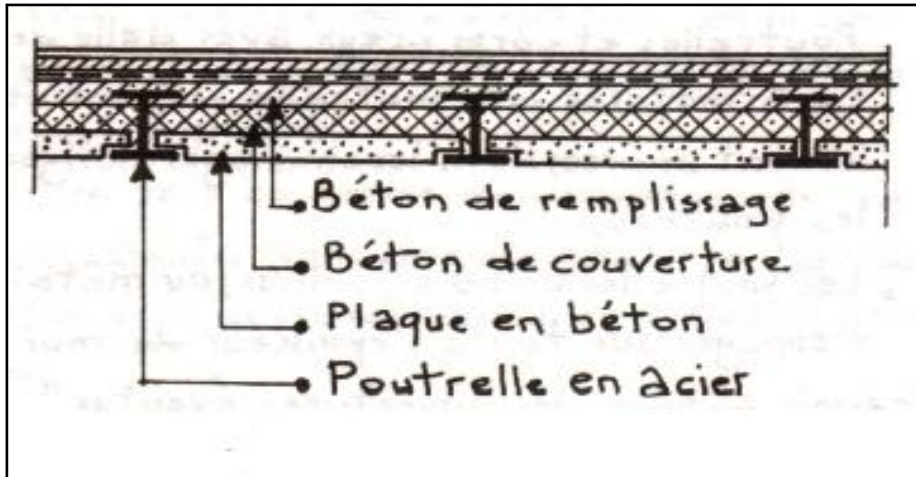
Plancher à poutrelles en acier et plaques de béton.
